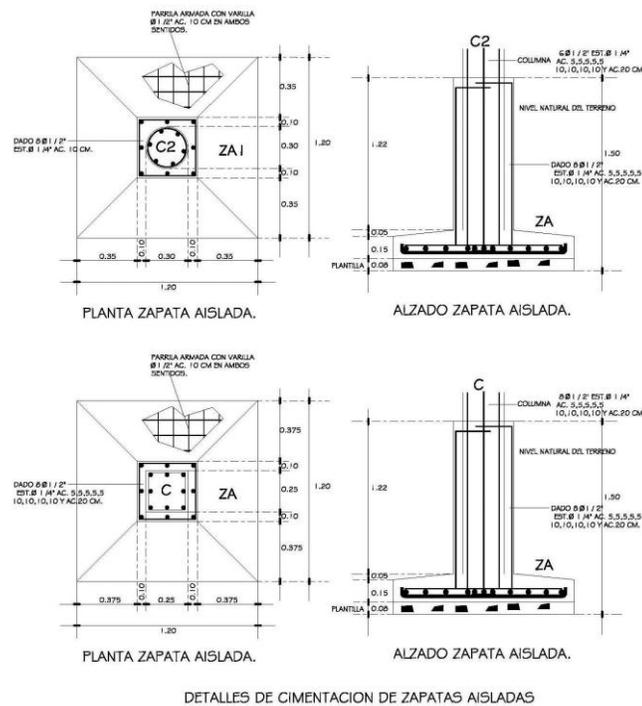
Detalle de cimentación de zapatas aisladas.
